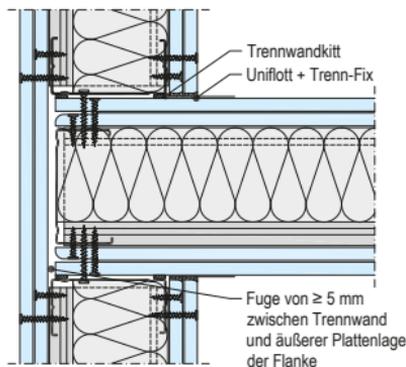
Darstellung Knauf Prüfaufbau Geschlitzte Flanke
